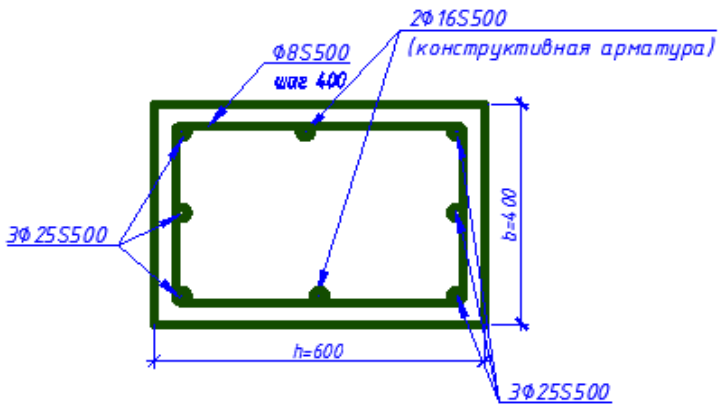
Размещение арматуры в поперечном сечении подкрановой части колонны
